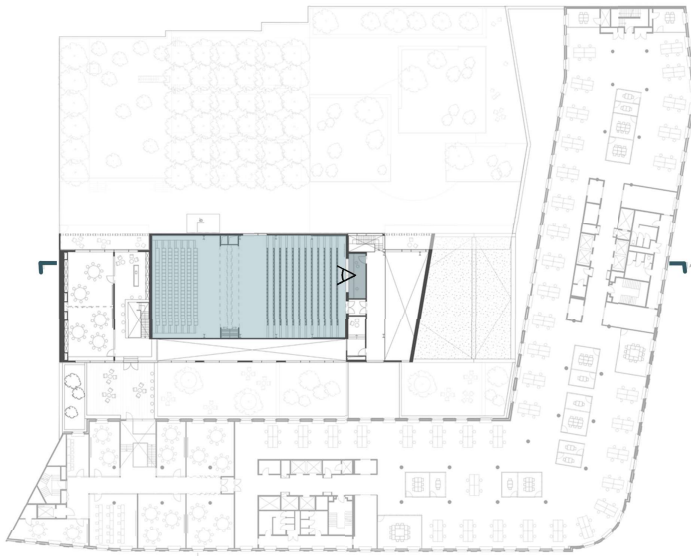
Diagrama de perspectiva y refugio sobre plano de la primera planta.
